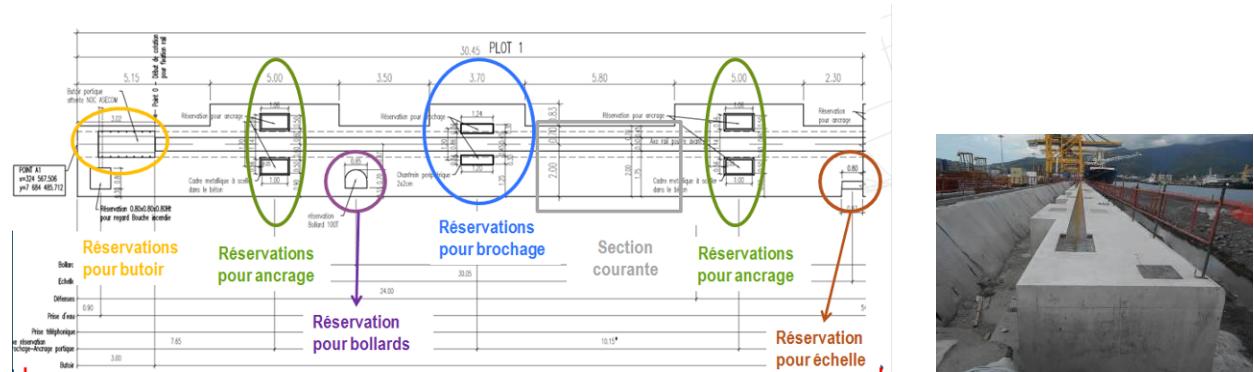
Réservations disposées sur un plot de la poutre de couronnement
